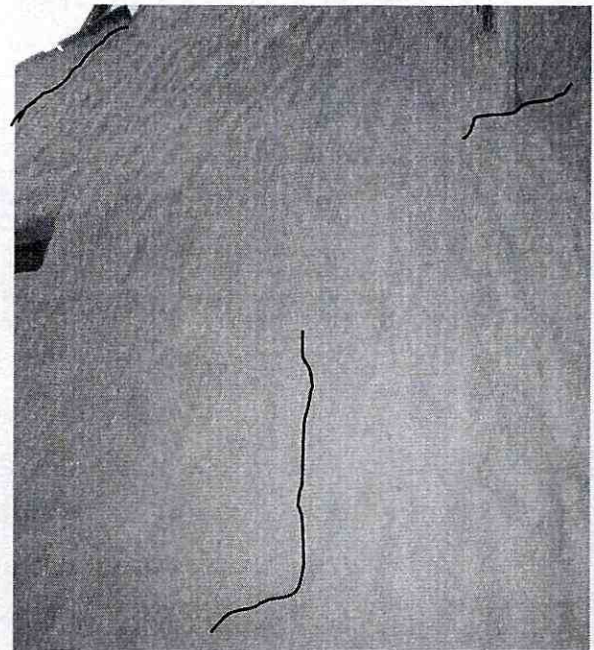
Al Exterior de la vivienda se pueden observar fisuras y grietas de hasta 10 milímetros de abertura.
